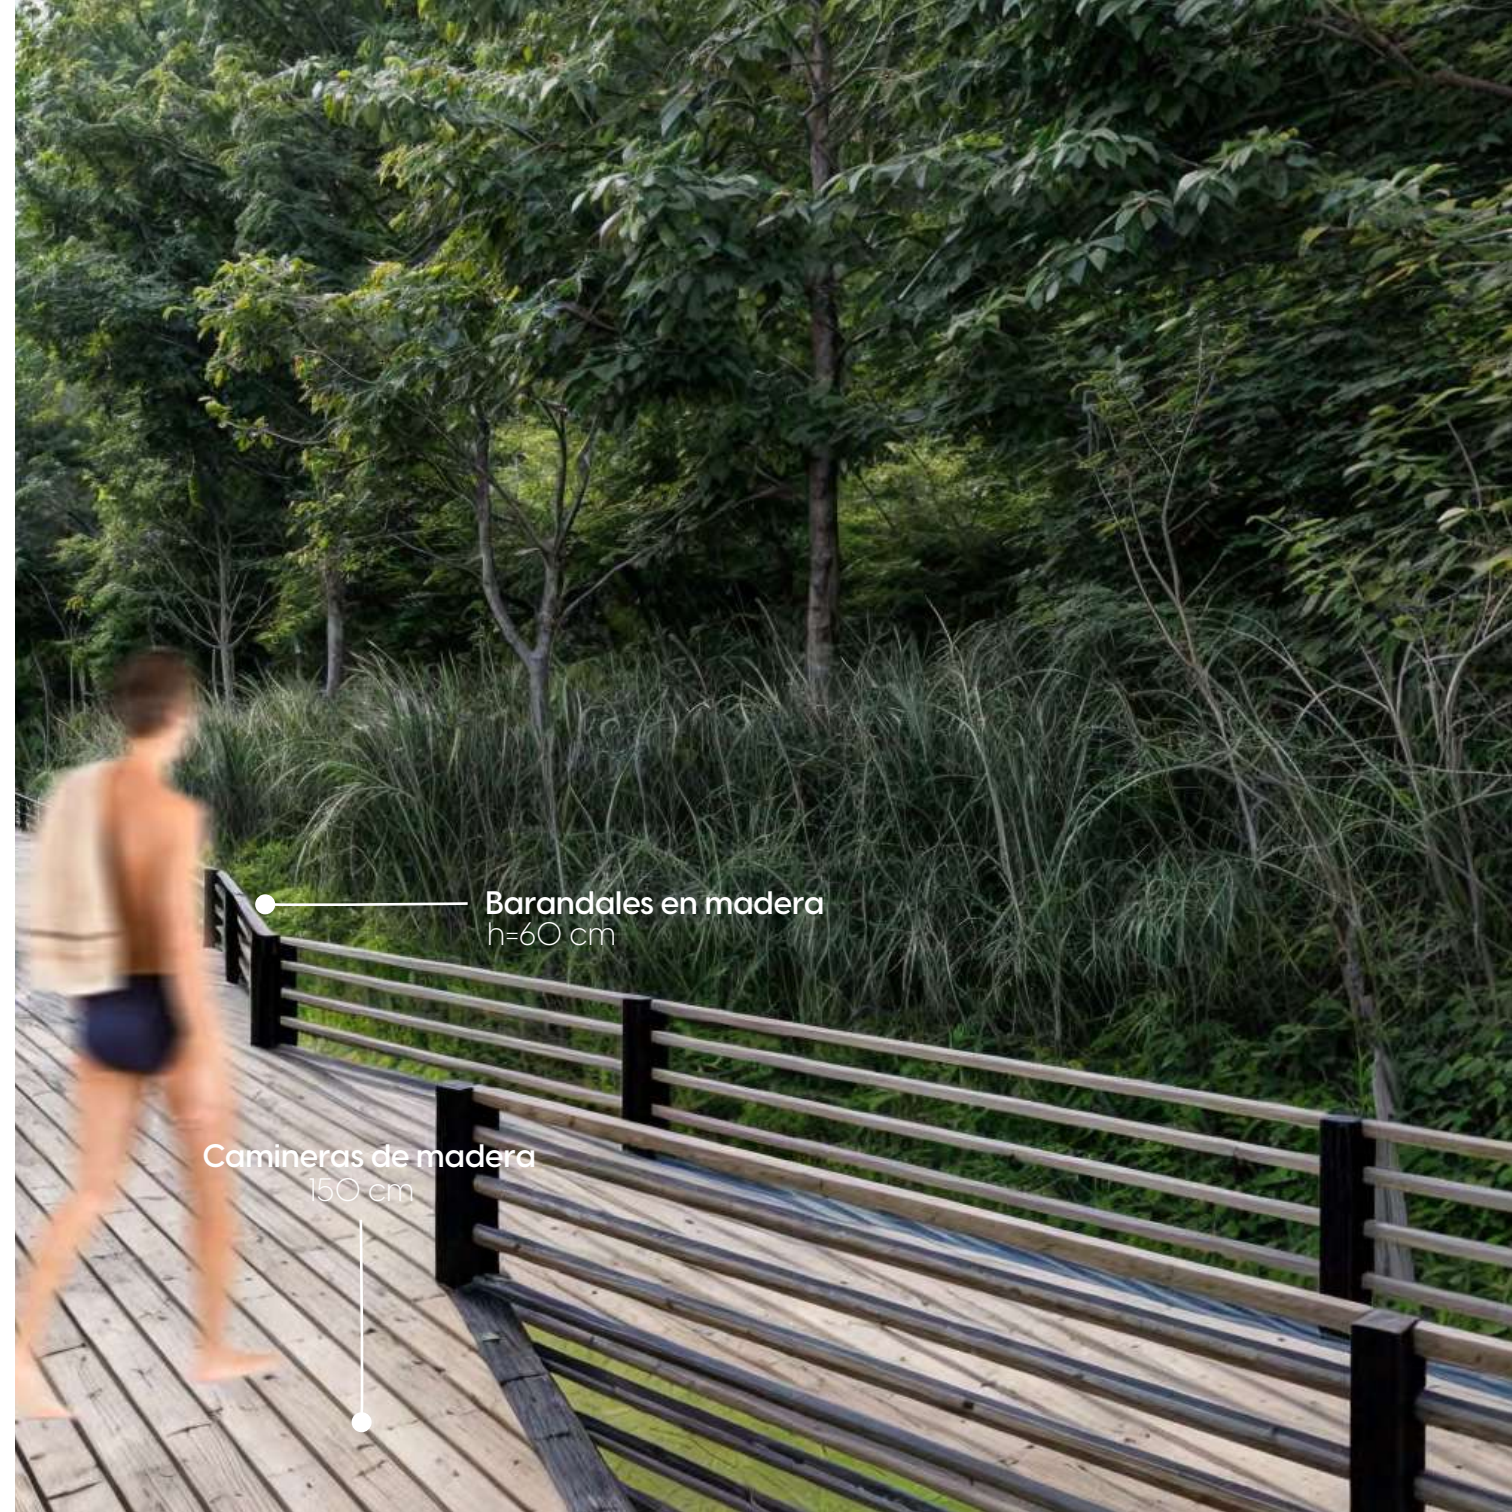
Plan de obra de las piscinas termales zona en desuso.
